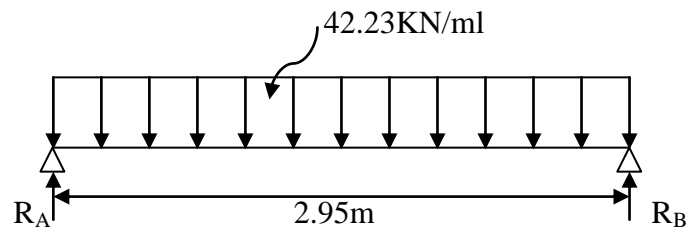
Schéma statique de la poutre palière l' ELU.
